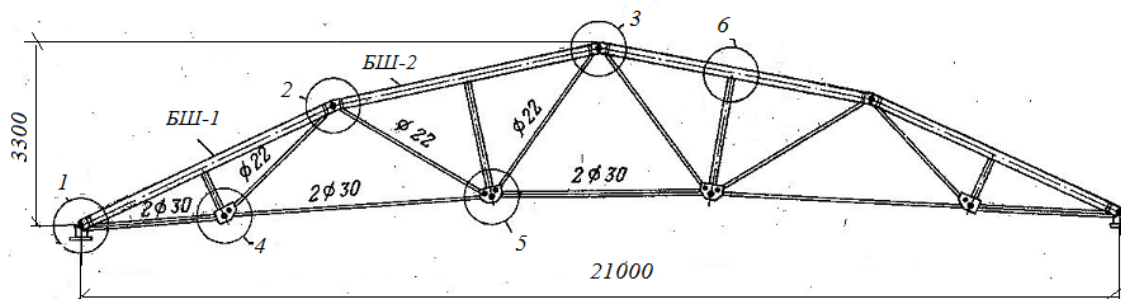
Пятиугольная ферма с узлами крепления пролетом 21 м с брусчатым верхним поясом (тип-5)
